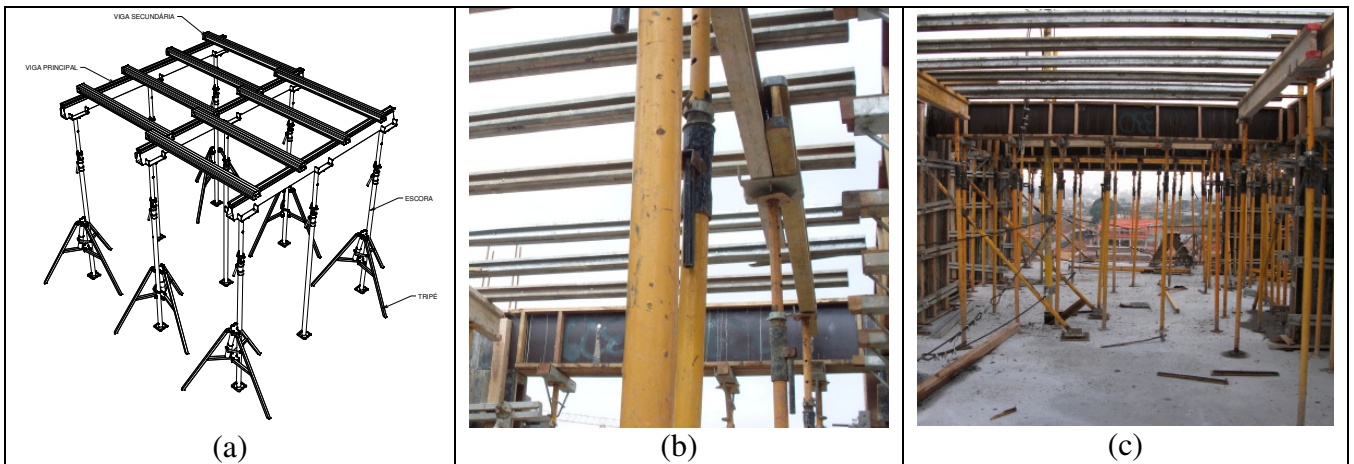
desenho e fotos ilustrativas do vigamento secundário das lajes
